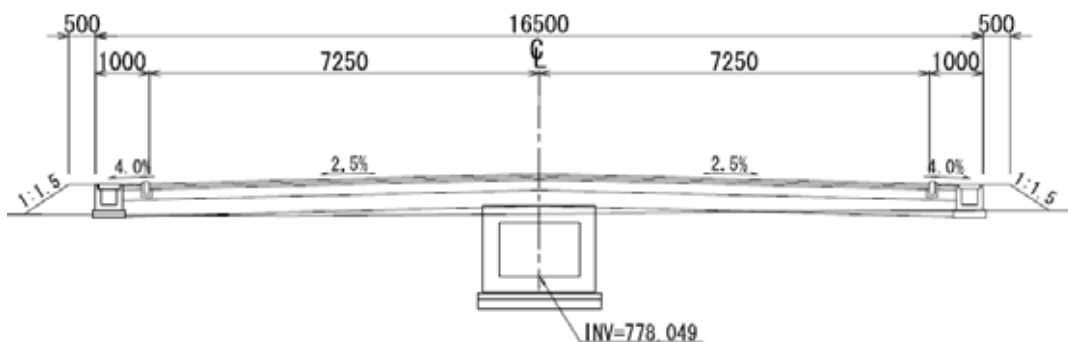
始点部の冠水被害軽減のための排水路横断面図
